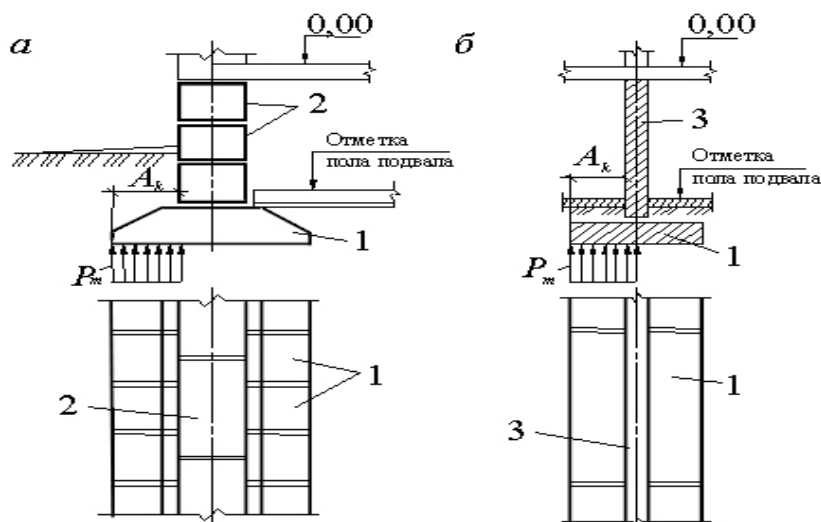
Сборные ленточные фундаменты: а – для кирпичных и блочных стен; б – для крупнопанельных стен; 1 – фундаментные плиты; 2 – стеновые фундаментные блоки; 3 – стеновые панели подвала
